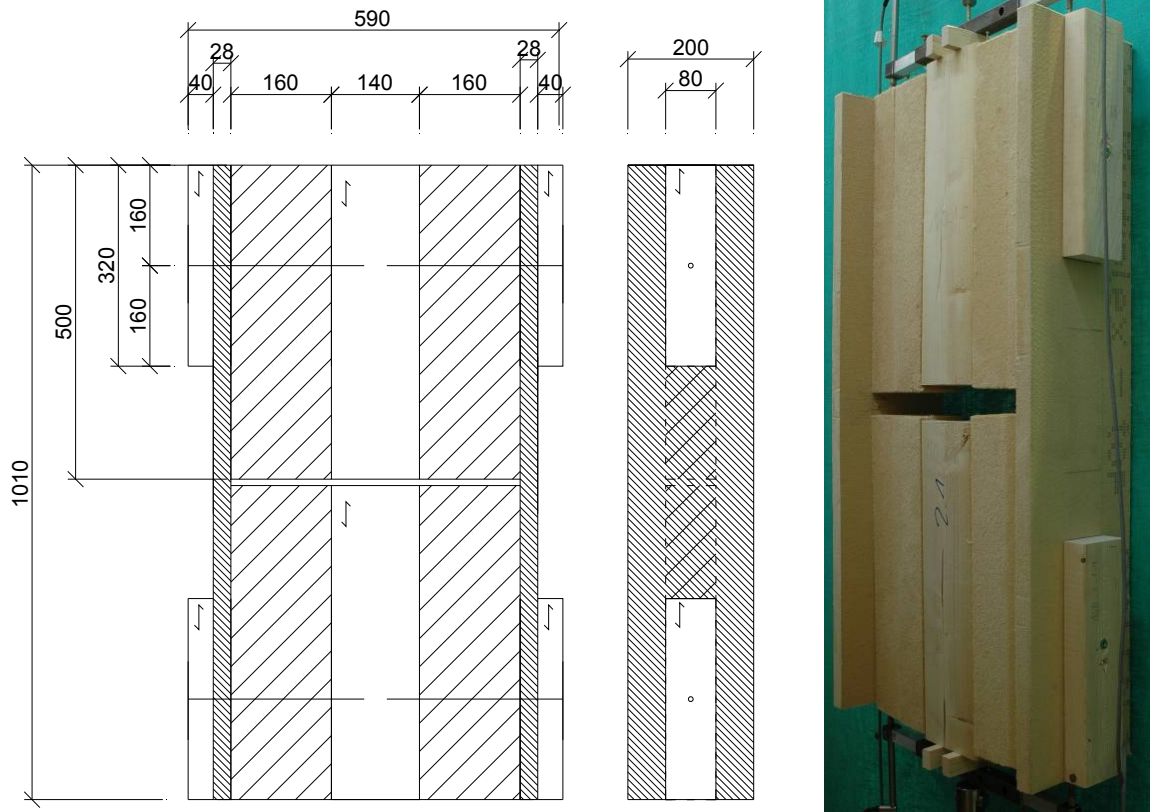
Zugscherkörper einer Holz-HFDP-Verbindung in einem einlagigen Aufsparrendämmsystem (Dämmschicht 1 x 160 mm, Maße in mm)
